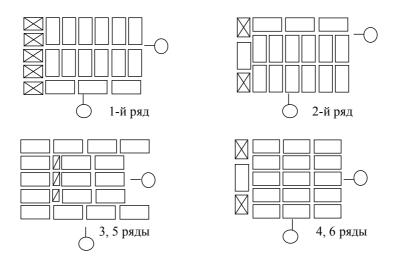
Кладка вертикальных ограничений стен толщиной в 2,5 кирпича
